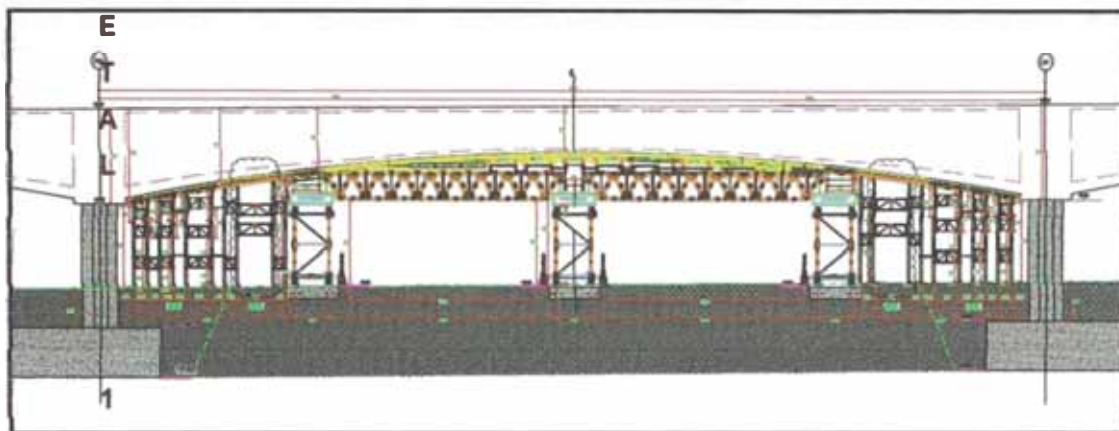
Vista de la Sección longitudinal del tramo central
